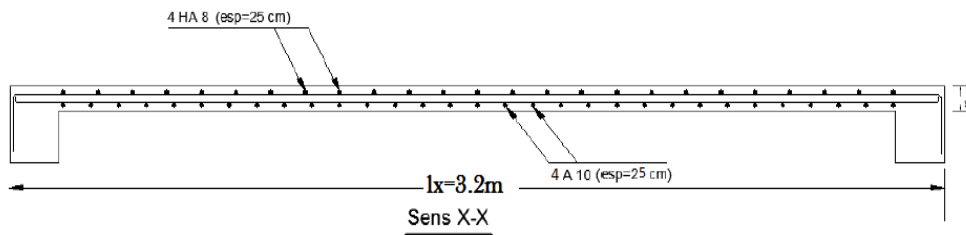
ferrailage de la salle machine sens (x-x)
